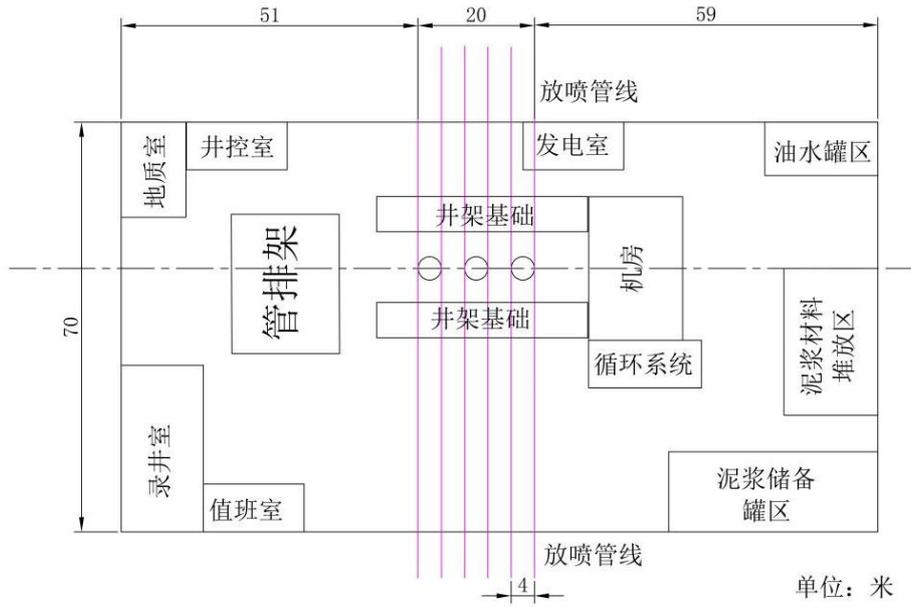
一字型三丛井井场施工平面示意图 (单位: m)
